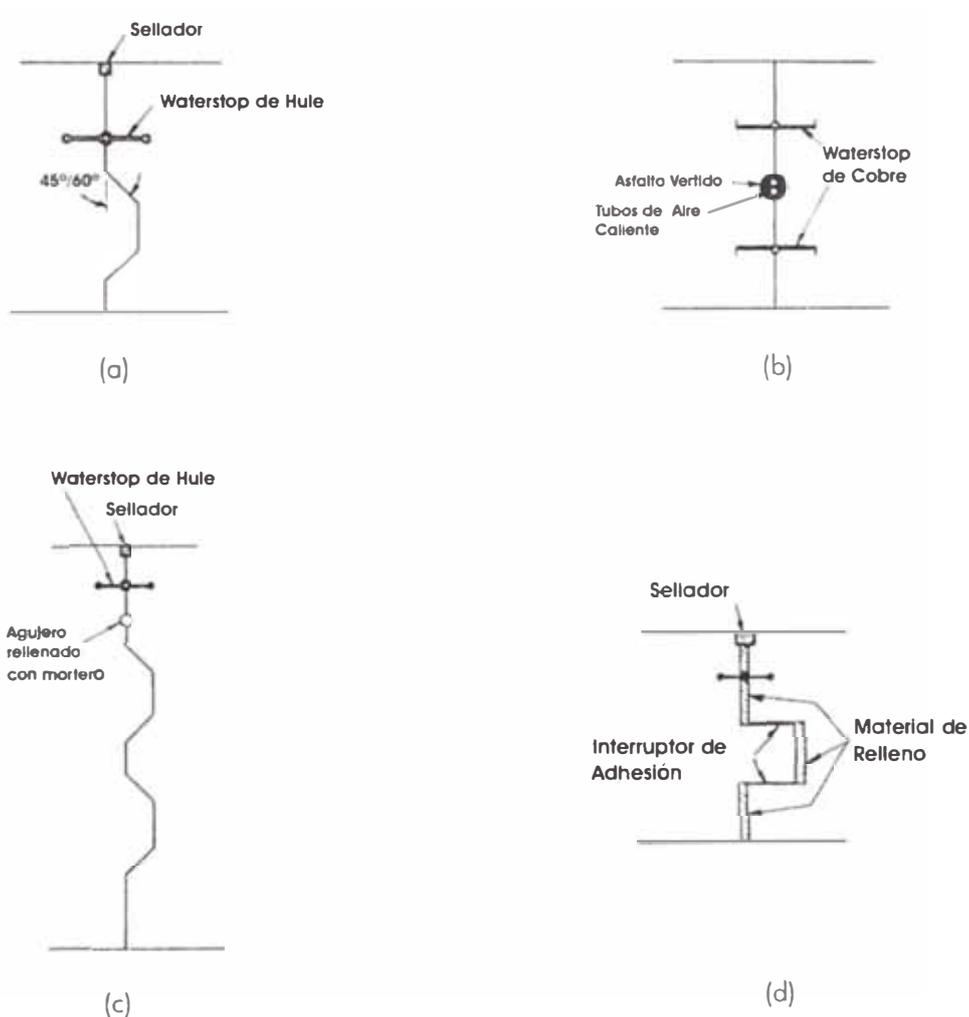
Detalles del diseño de juntas en estructuras de concreto masivo
